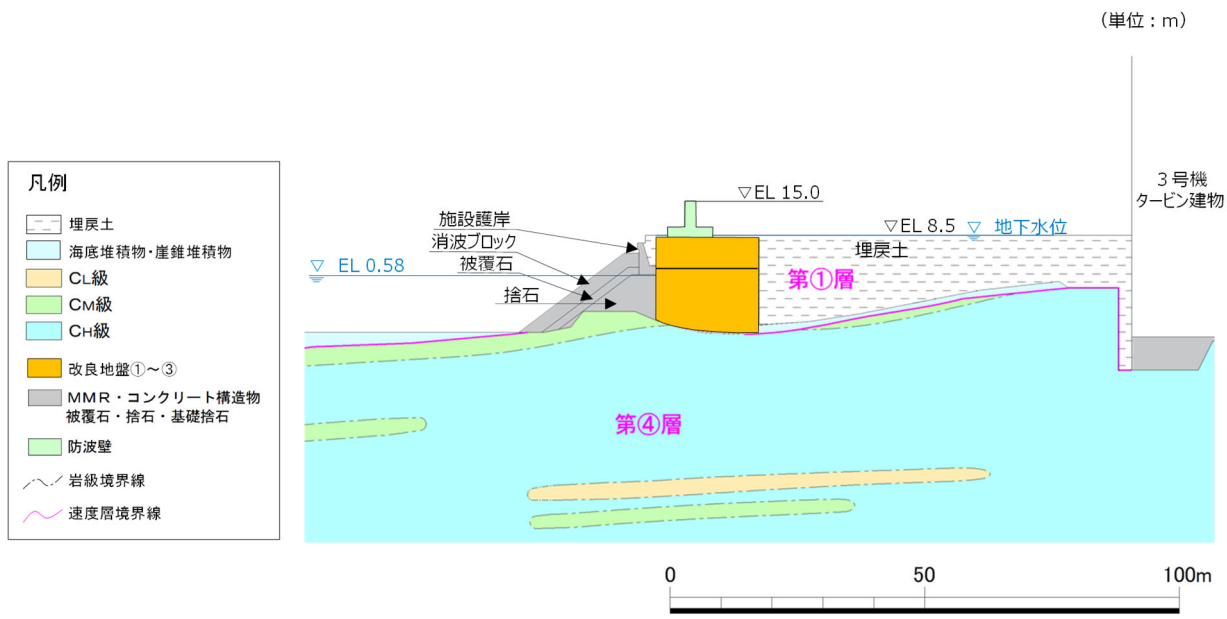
防波壁（逆 T 擁壁）の横断面図（⑤-⑤断面）
